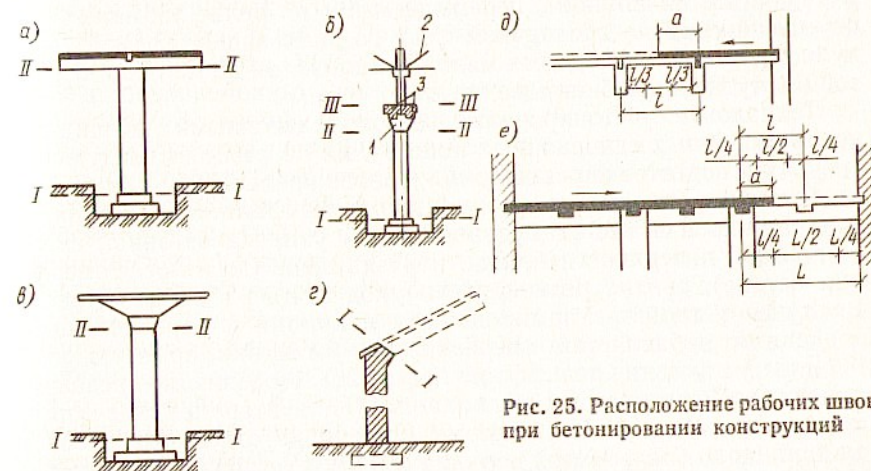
Расположение рабочих швов при бетонировании конструкций
